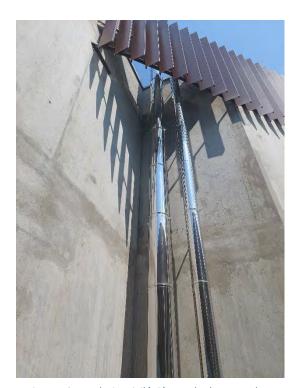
Endroit privilégié pour la descente des câbles depuis la toiture
